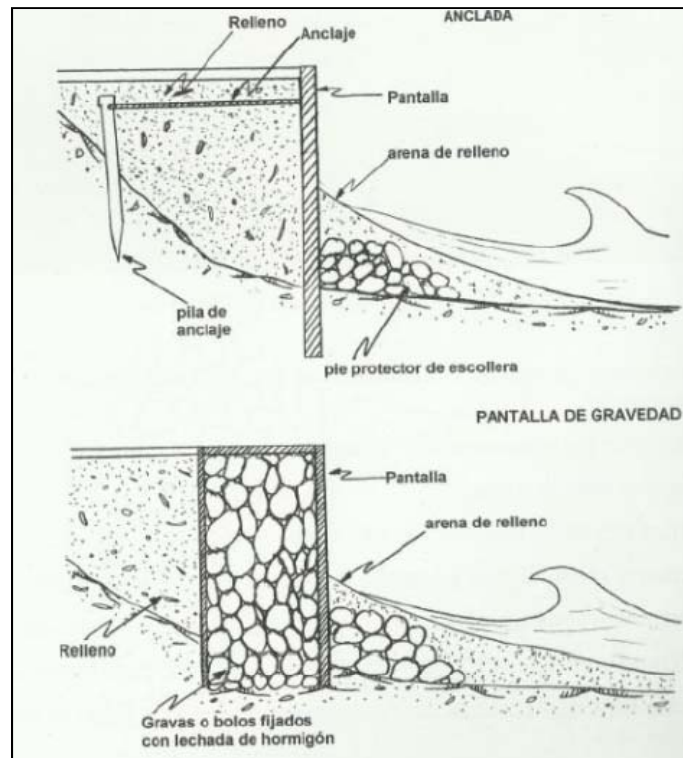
Tipos de muros mamparo para la defensa costera (Modificado del CERC 1984).
